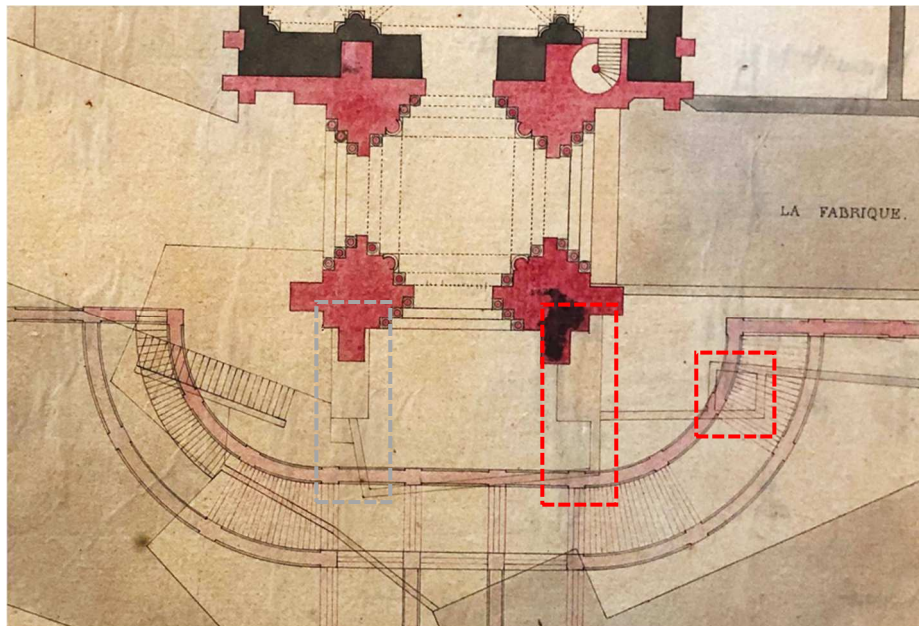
Plan de la reconstruction d'A. Bailly / [HI -02] 1849
